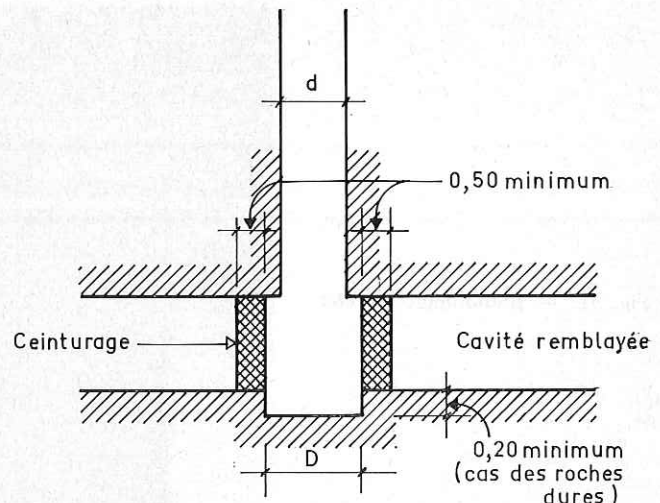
Empatement éventuel et ceinturage à la base des puits dans la traversée d'une cavité non effondrée.
